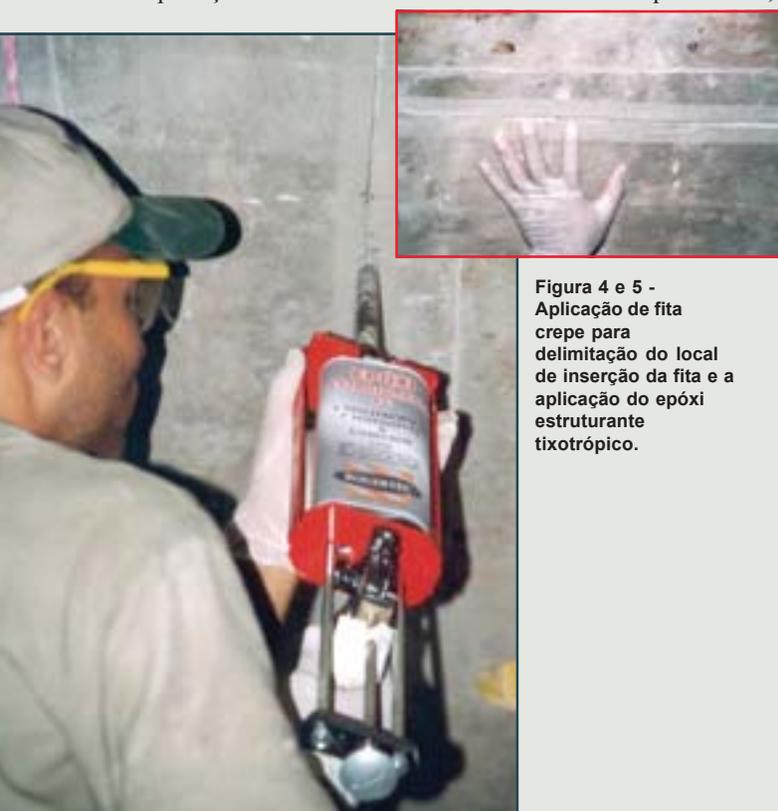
e 5 - Aplicação de fita crepe para delimitação do local de inserção da fita e a aplicação do epóxi estruturante tixotrópico.
